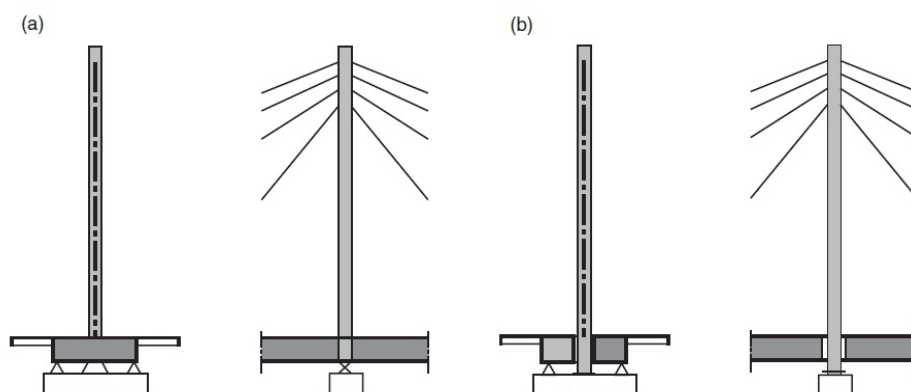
Sisteme structurale pentru piloni centrali care susțin sisteme de cabluri într-un singur plan central
